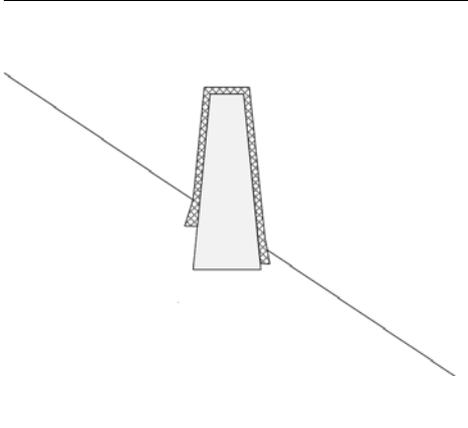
> Mit Spritzbeton sanierte Trockenmauer
